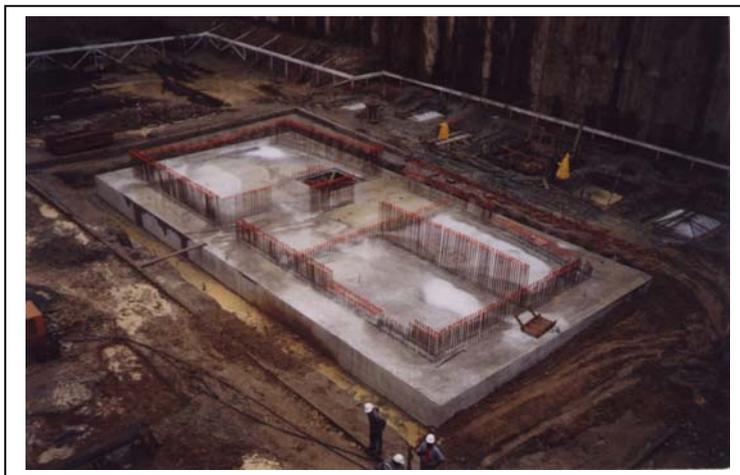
Vista Panorâmica da Sapata e Arranques dos Pilares do Núcleo
